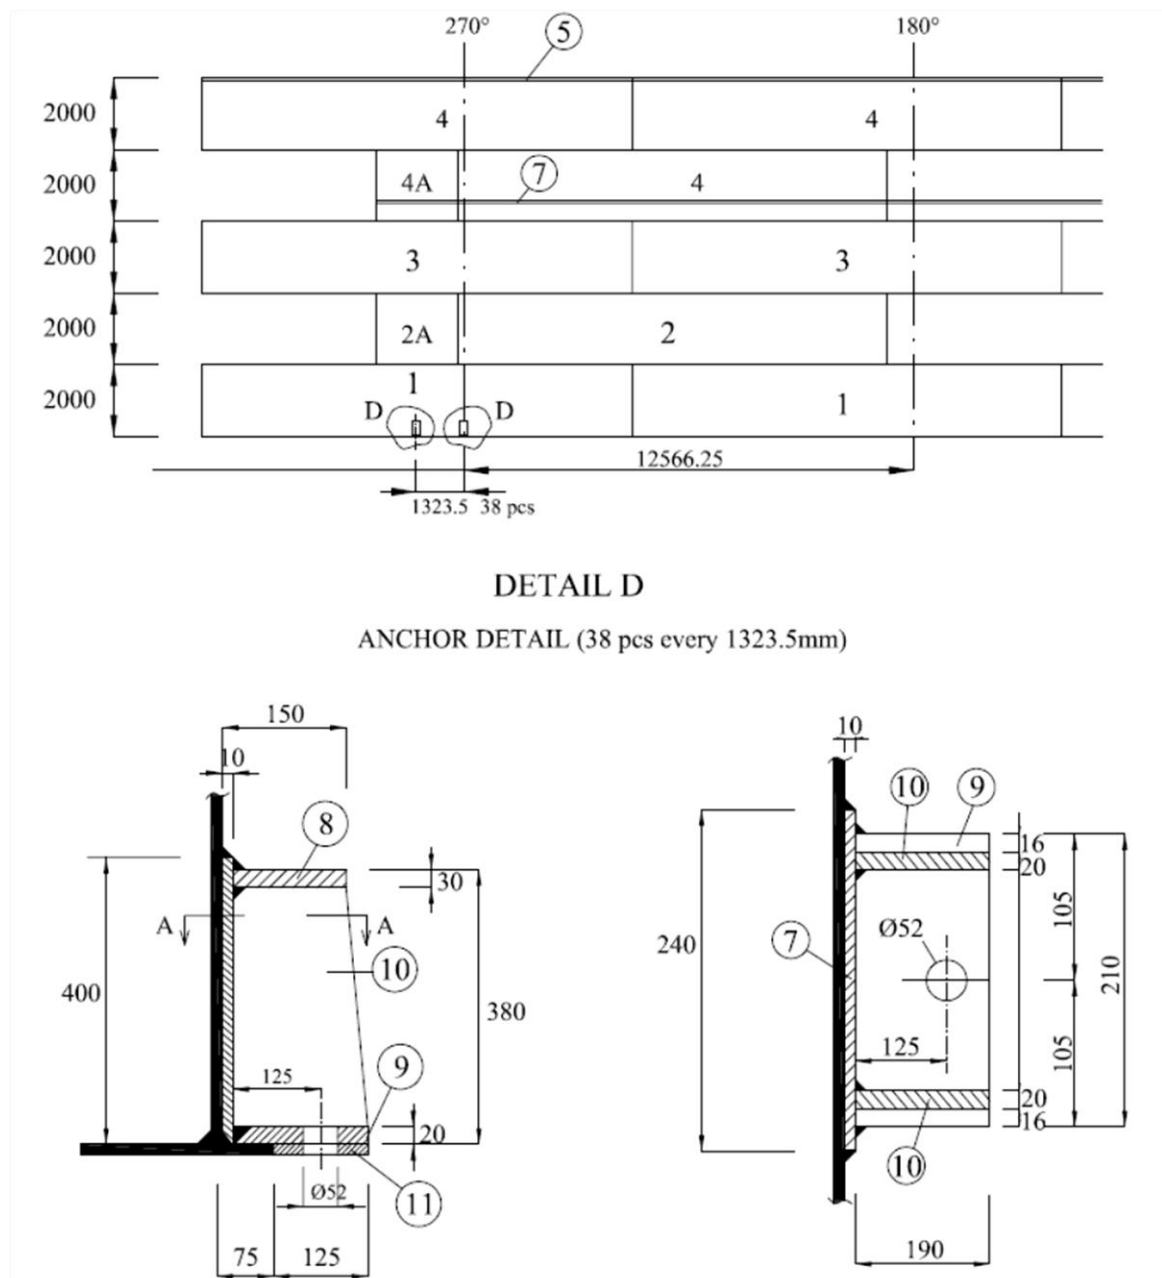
In alto porzione del prospetto del mantello “steso”, sotto dettagli degli ancoraggi tra serbatoio e fondazione.
